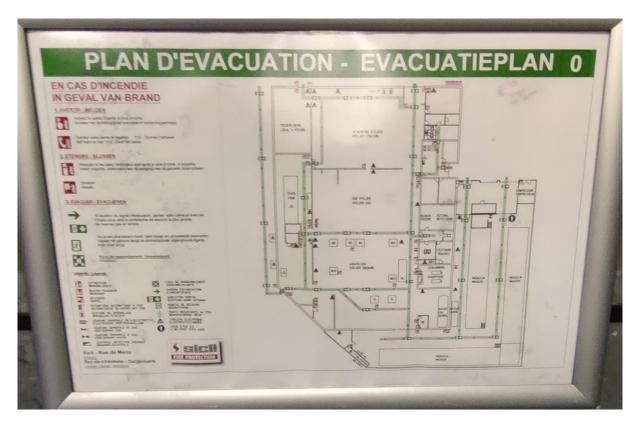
Extrait de plan d'évacuation du bâtiment industriel
